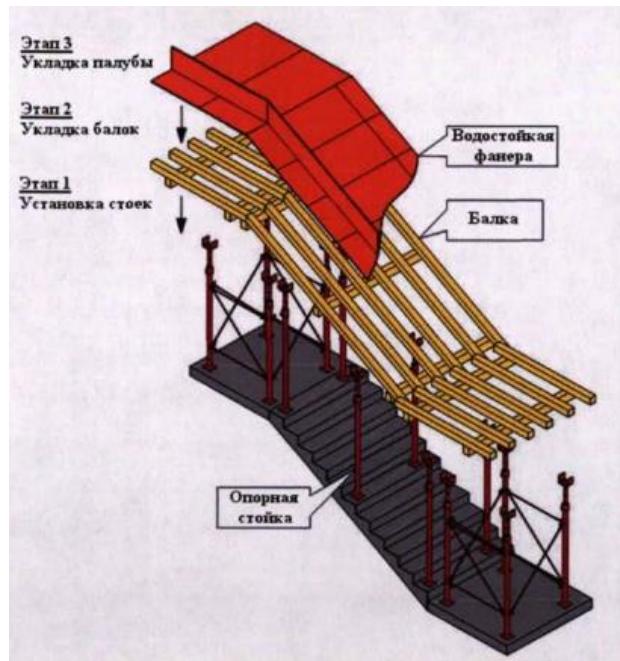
Монтаж индивидуальной опалубки для лестничного марша и площадок.
